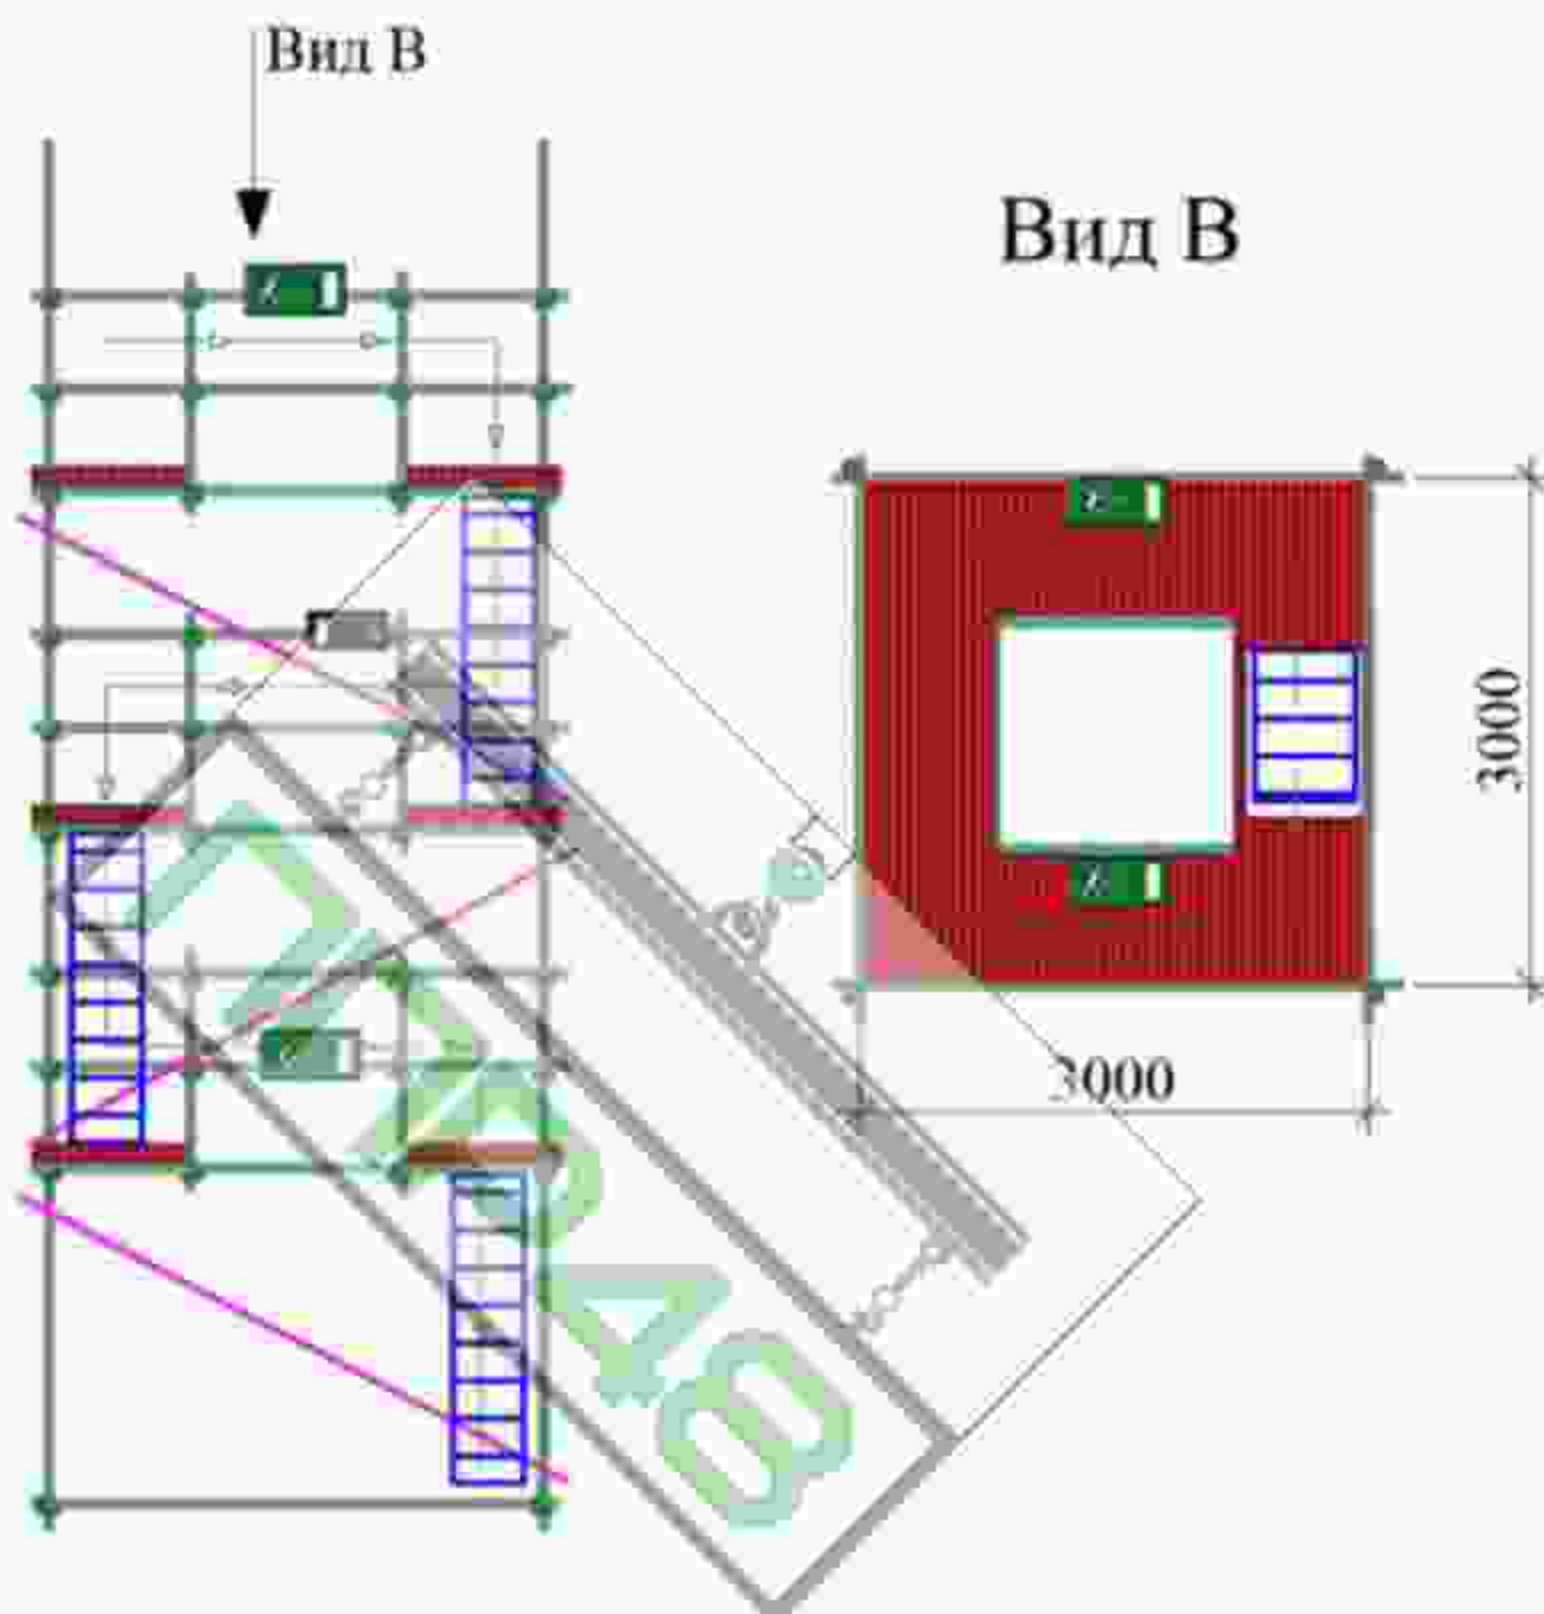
Строительные леса хомутового типа для работ по монтажу армокаркаса, опалубки и бетонирования
